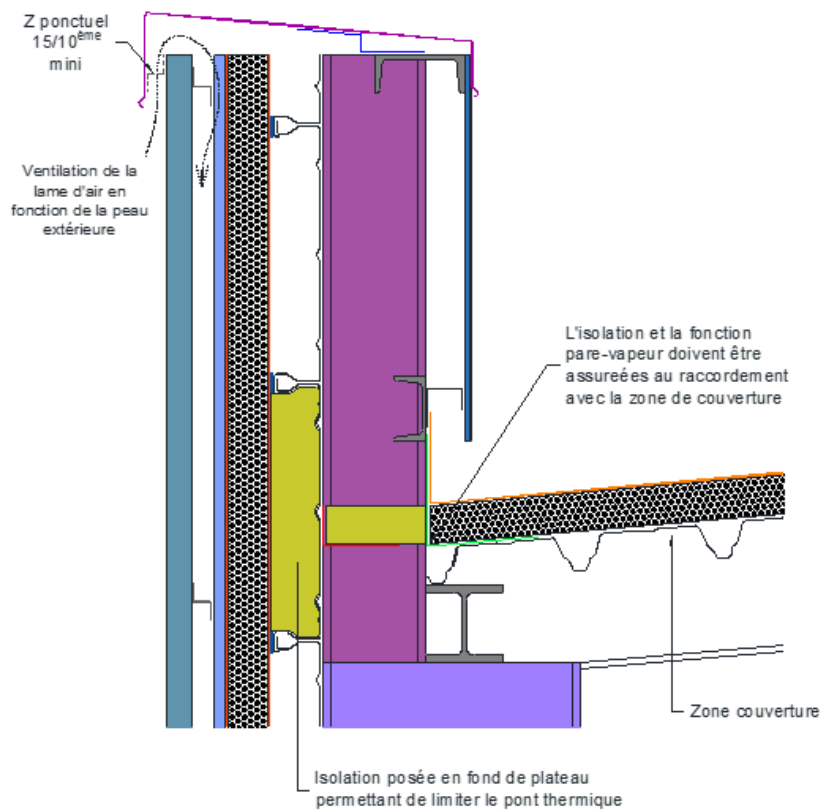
Coupe sur bardage triple peau en partie haute et raccordement avec la partie couverture (plateaux horizontaux)
